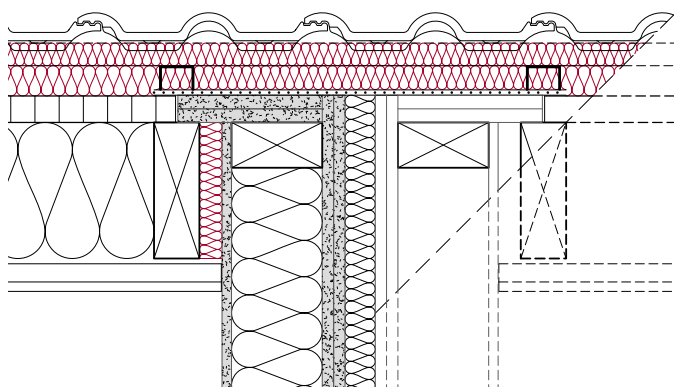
Anschluss Gebäudetrennwand an ein Steildach mit Zwischensparrendämmung. Die Lattung ist getrennt.
